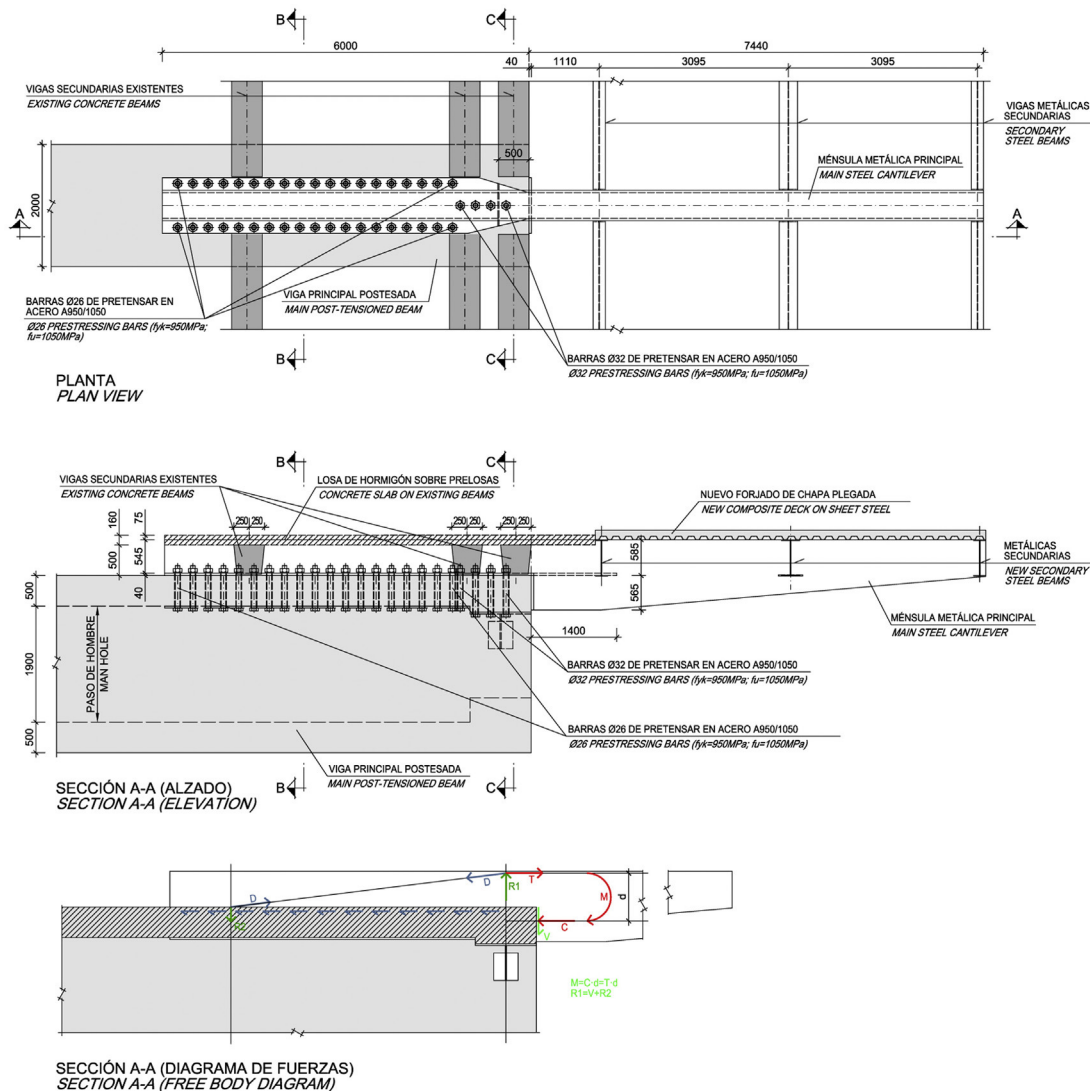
Ménsula voladizo by-pass (planta y alzado). Ver secciones B-B y C-C en la figura 27.
